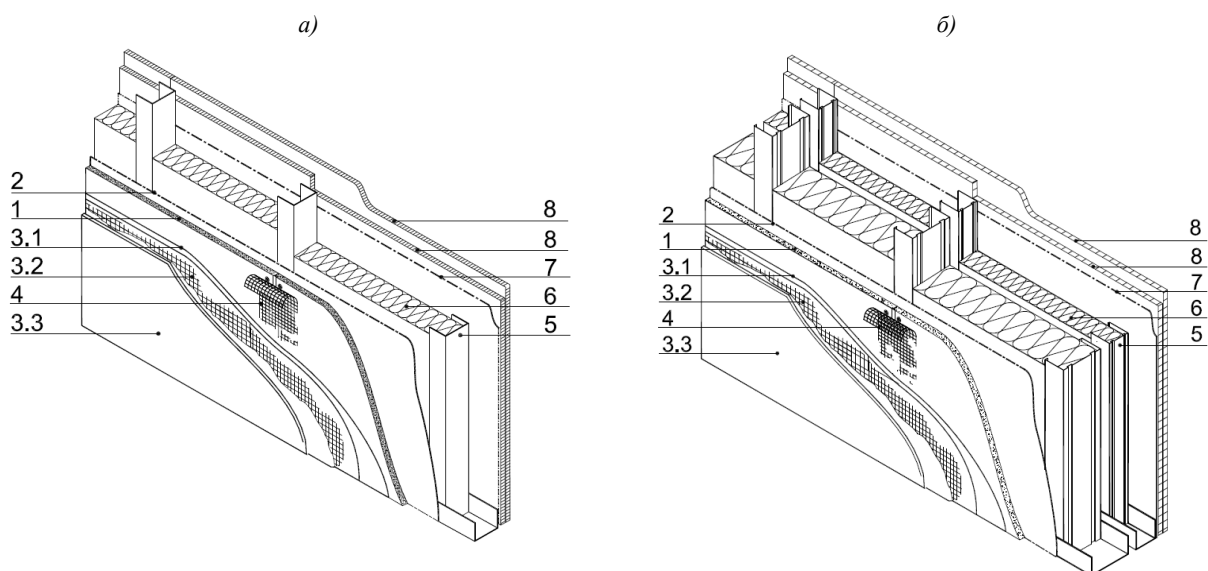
Наружная стена с прямым креплением плит к стальному каркасу: а) на одинарном каркасе; б) на двойном каркасе, где 1 - цементная плита AQUAPANEL Outdoor; 2 - паро-гидробарьер AQUAPANEL TYVEK StuccoWrap; 3.1 - армирующий и клеящий раствор AQUAPANEL; 3.2 - сетка для наружных работ AQUAPANEL; 3.3 - штукатурная накрывка AQUAPANEL; 4 - шпатлевка для швов AQUAPANEL - серая и лента для швов AQUAPANEL; 5 - несущий профиль; 6 - изоляционный материал (KnaufInsulation или Heraklith); 7 - пароизоляционный слой; 8 - гипсокартонная плита КНАУФ.
